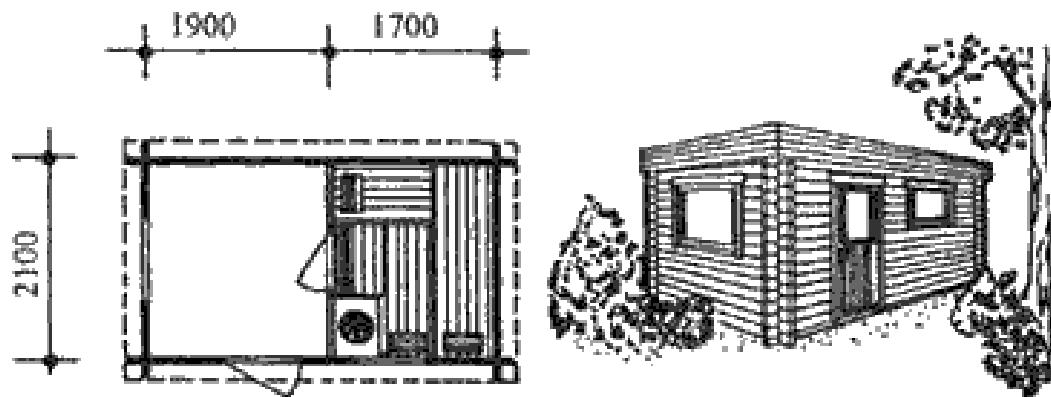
Фасад и план сауны на 3 человека с предбанником и открытым крыльцом.
